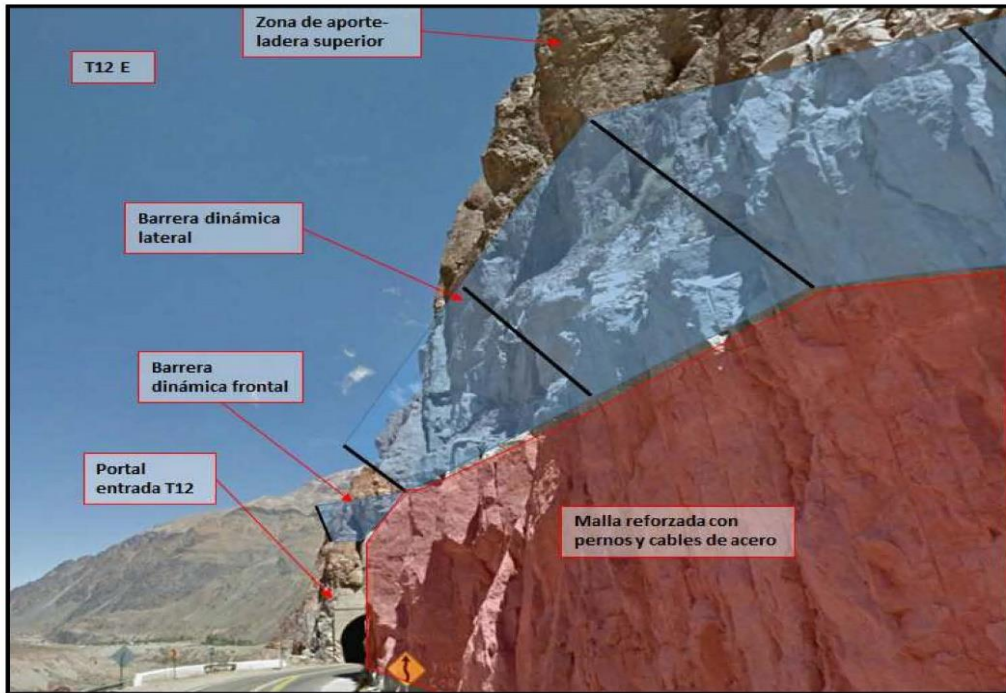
Esquema de protección de laderas propuesto para el portal entrada del túnel 12.
